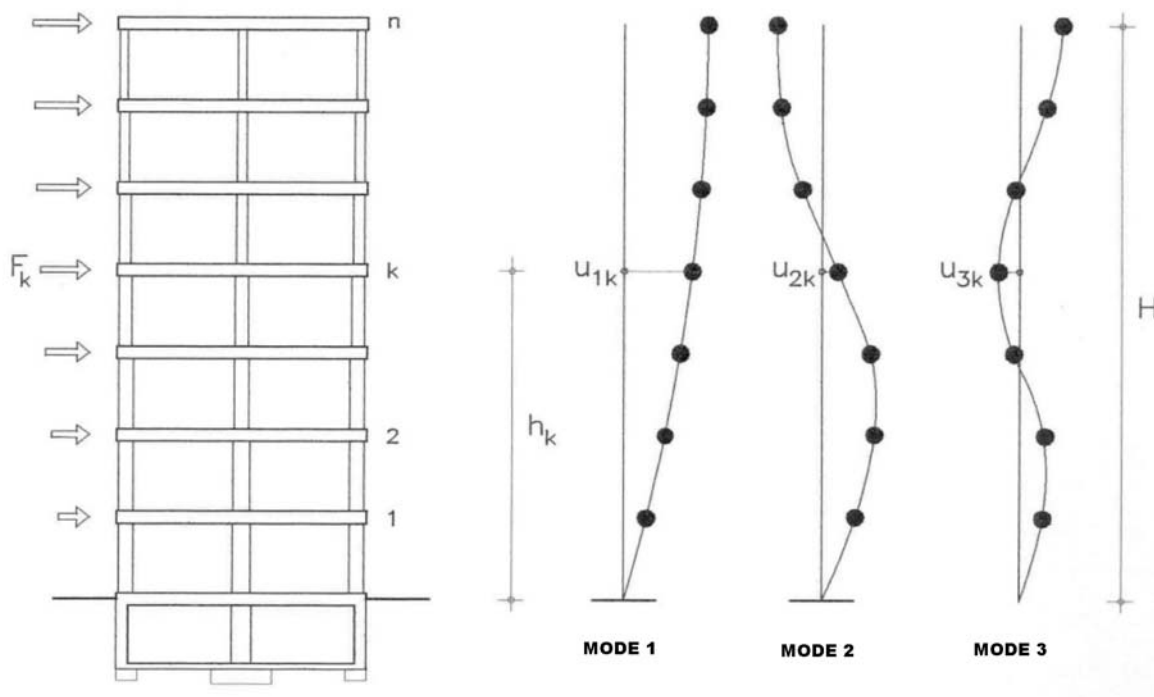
Modes de vibració en models plans d'estructures de pisos.
